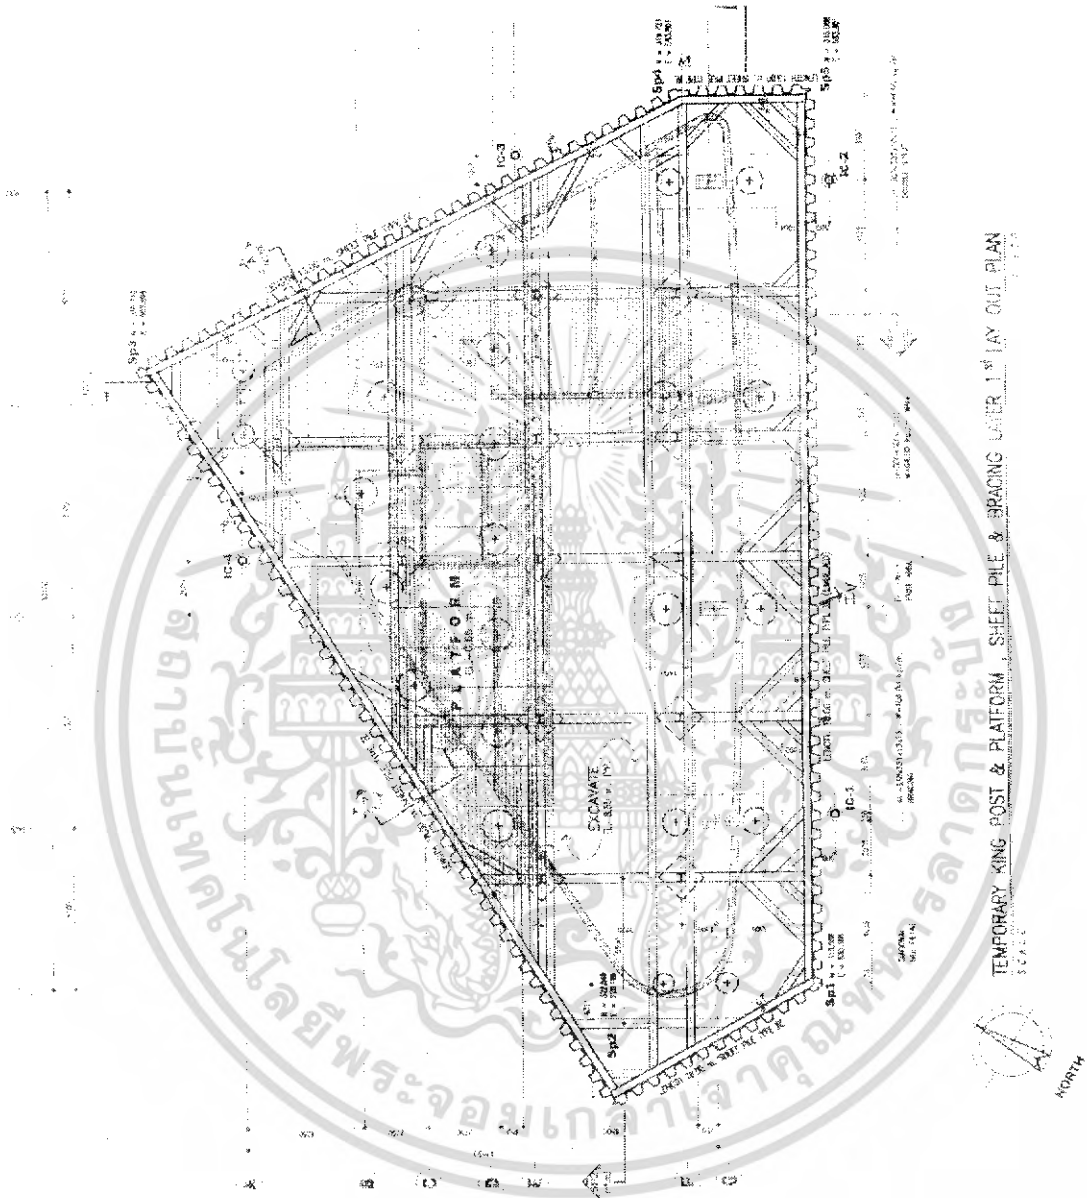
แสดง plan และรูปตัด Bracing layer 1 ของโครงการ The Met
